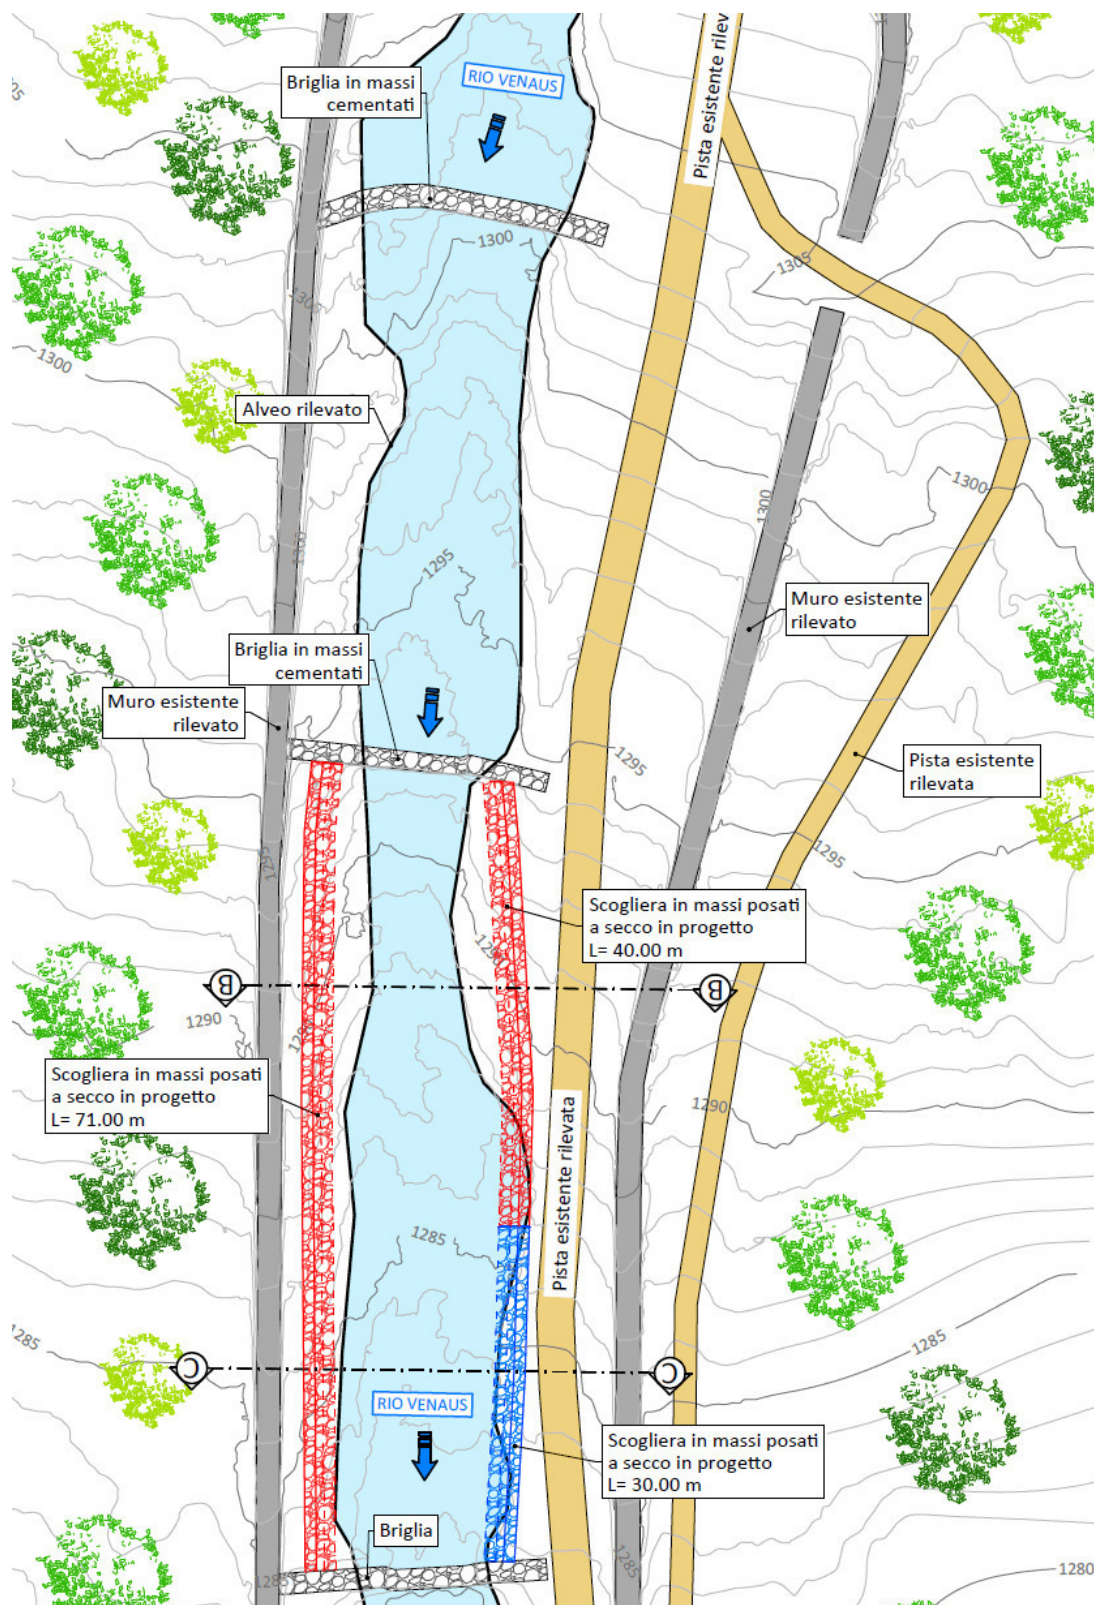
Estratto della planimetria Tav.05 Planimetria di progetto.
